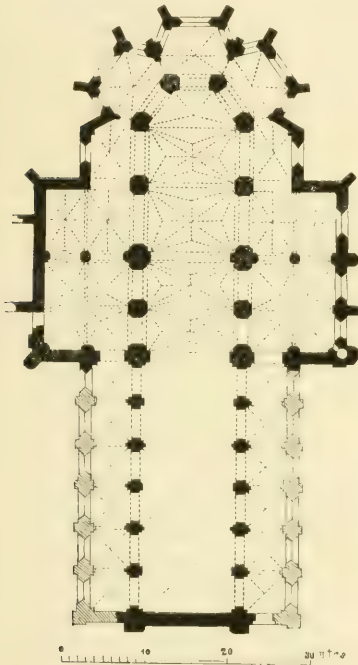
Grundriss von Dargun. (Nach Dohme)
